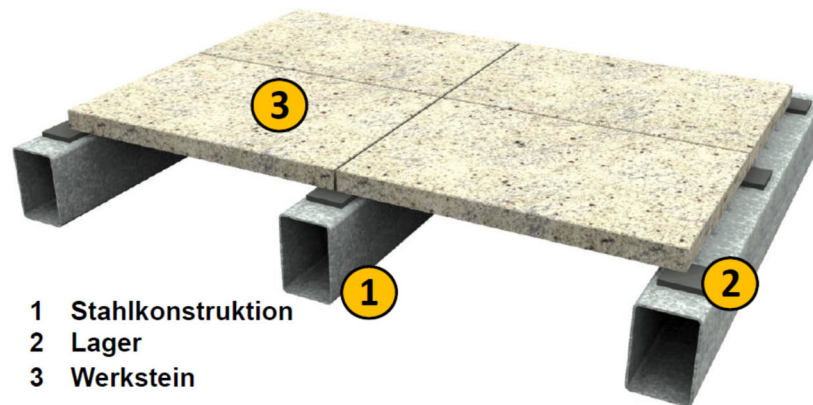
Ausführung auf einer Stahlunterkonstruktion
